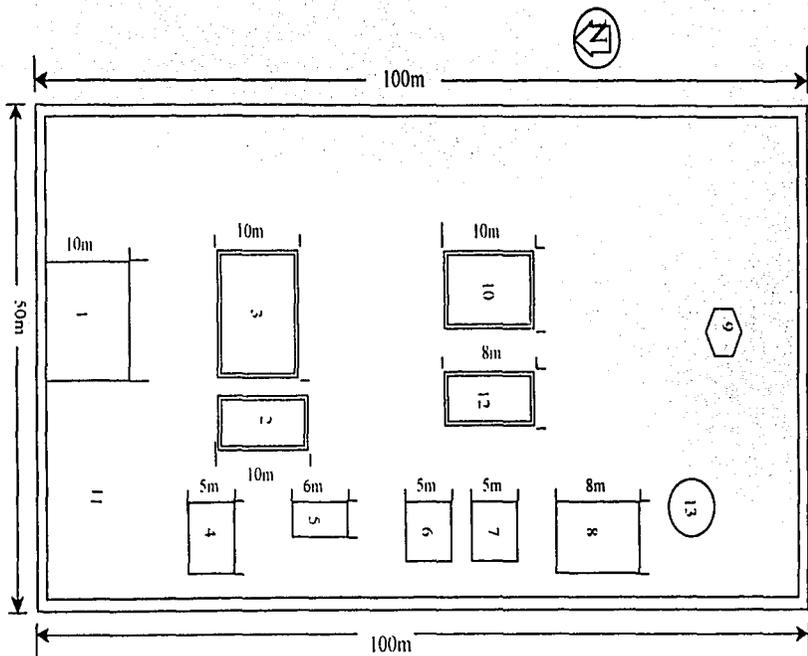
Croquis de ubicación del predio donde se instalará la planta recicladora
